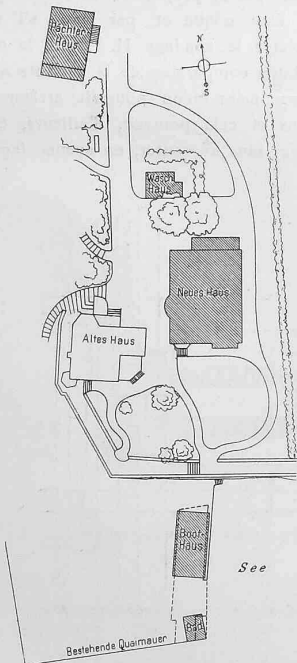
Lageplan des Landhauses «zum Flühli». — 1:1200.
